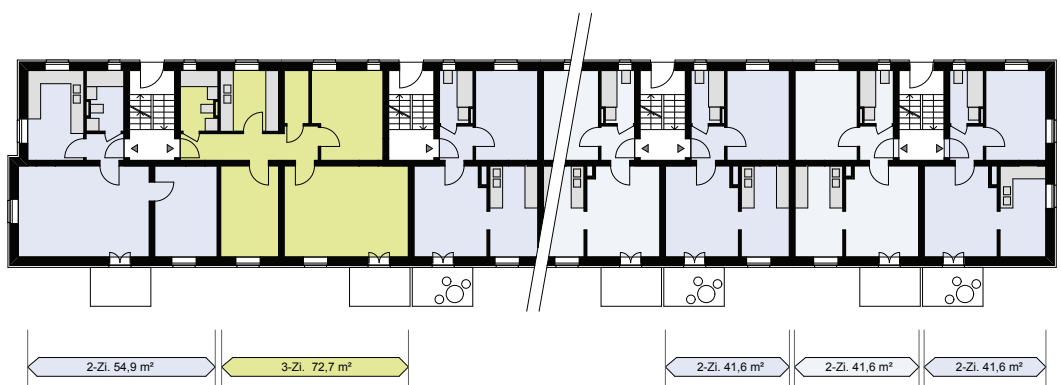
Grundrisse Regensburg, Kriemhildstraße 9–17
